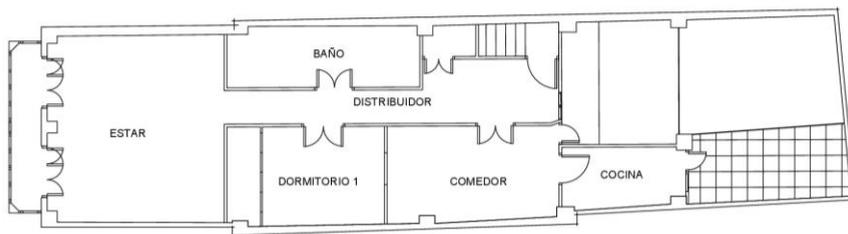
Plano distribución de planta segunda. 2018. Fuente: Propia
